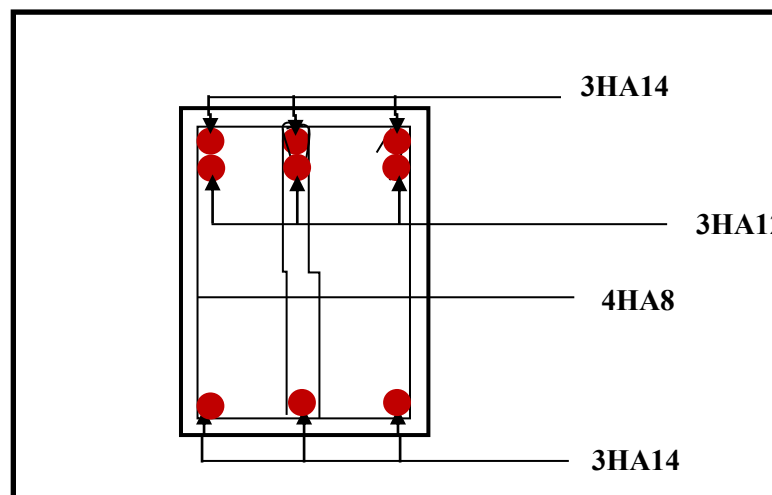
Ferrailage sur appuis d'une poutre principale.
